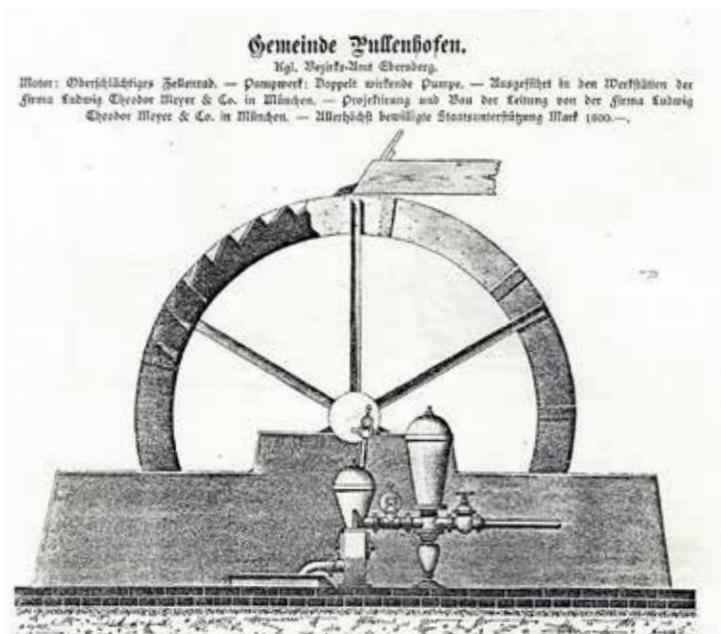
Plan zum Wasserleitungsbau in Pullenhofen.
